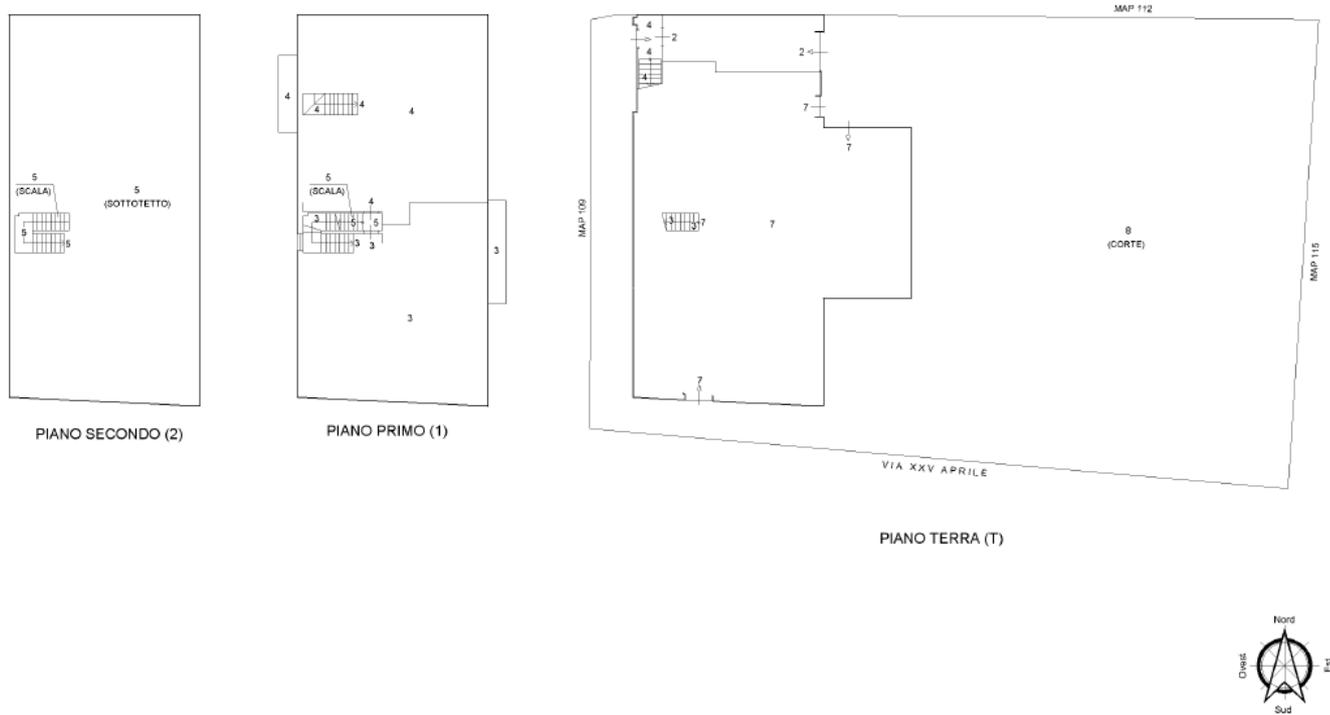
Planimetria catastale sub. 2 – LOTTO 2
